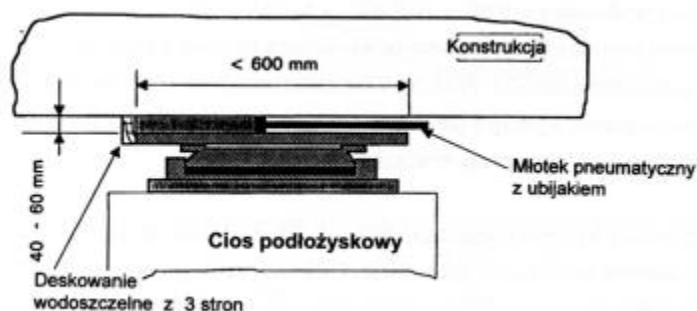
Ustawianie łożyska w przypadku konstrukcji betonowanej na miejscu
